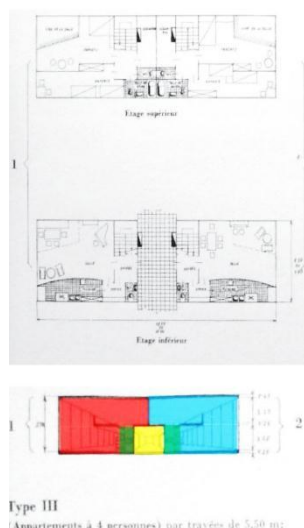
L'Ilot Insoluble*, planta do tipo 6, rua interior
